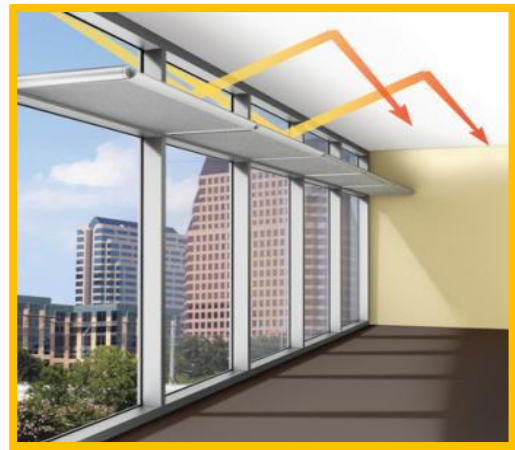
Étagère horizontale – [www.archrecord.construction.com](http://www.archrecord.construction.com)
